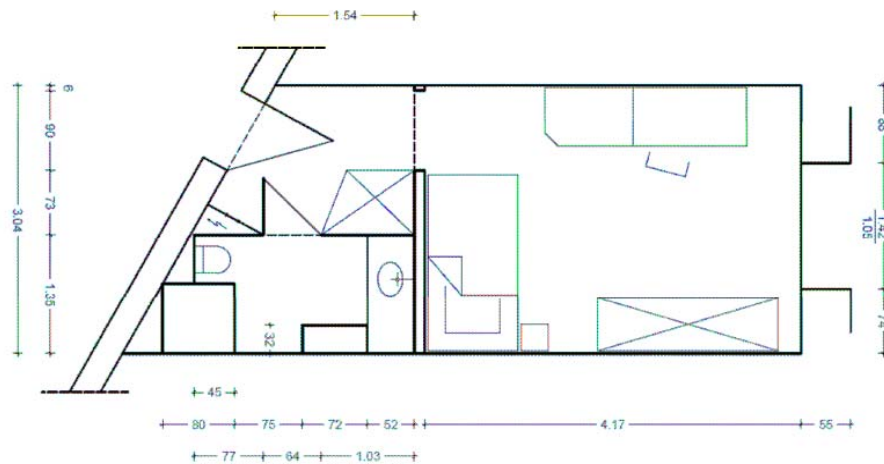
Grundriss des betrachteten Hotelzimmers
